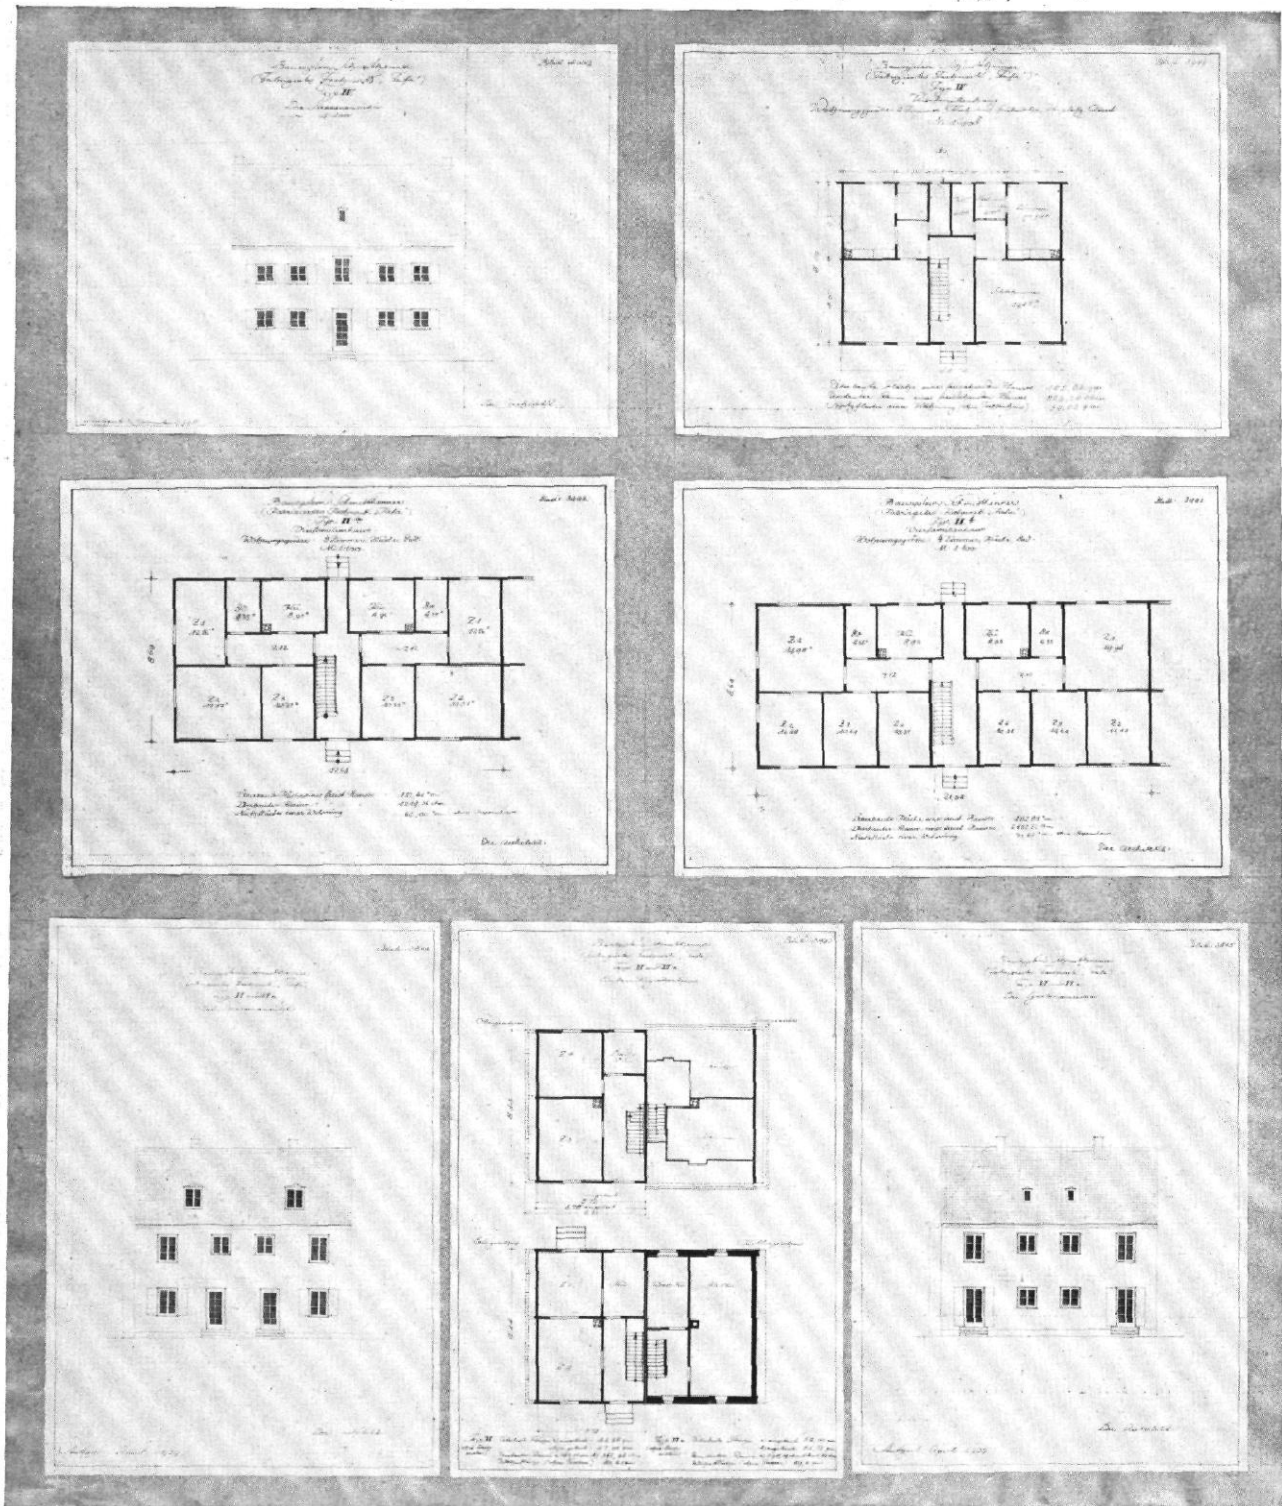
| Verschiedene Kleinwohnungsgrundrisse in fabriziertem Fachwerkssystem | Architekt: Paul Schmittbenner, Stuttgart
